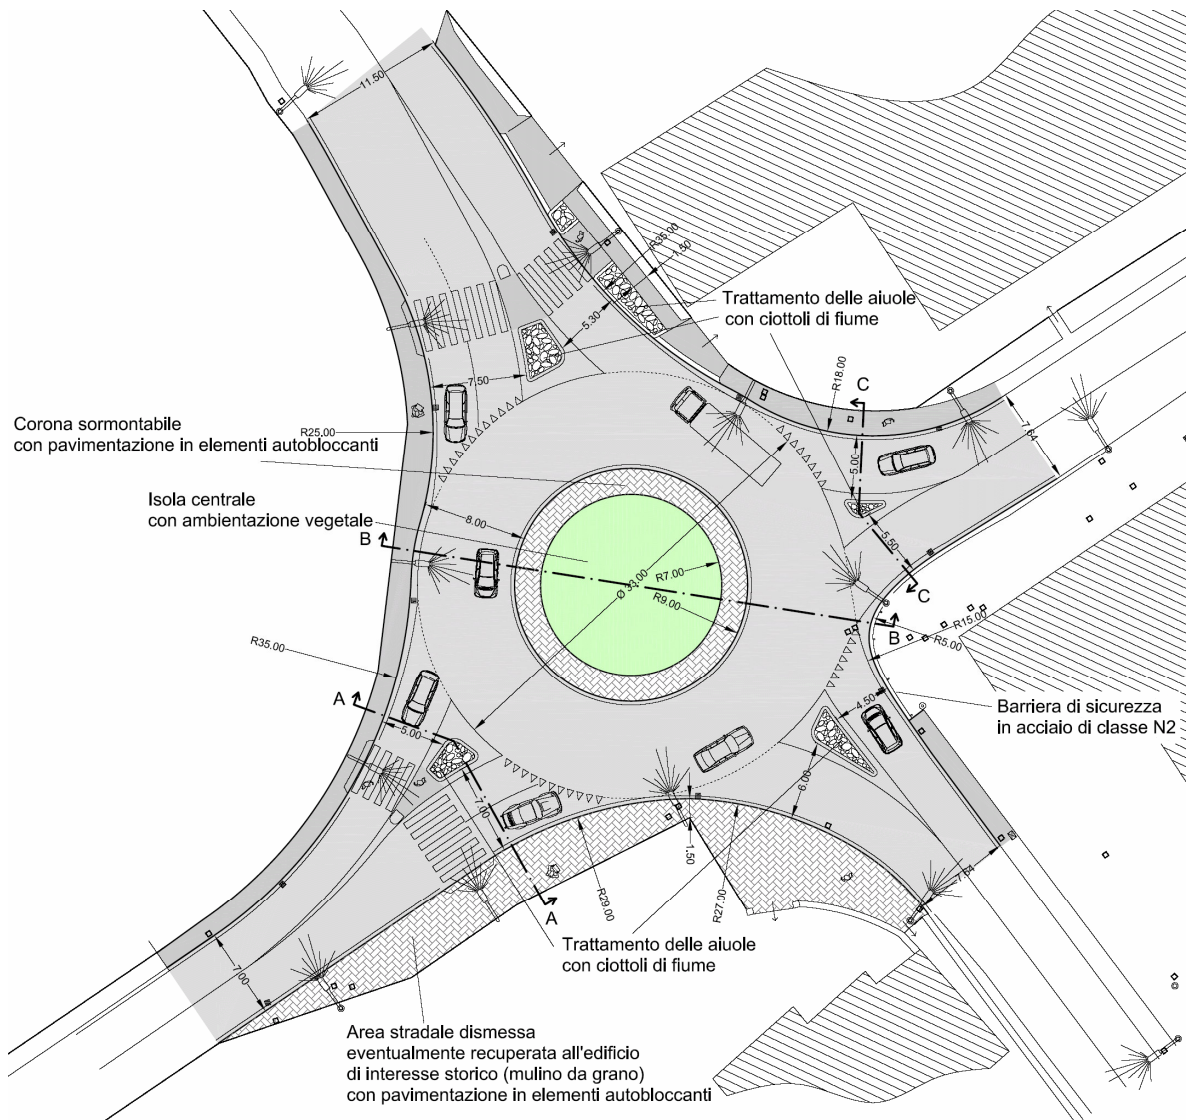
Ipotesi di sistemazione definitiva a rotonda dell'intersezione di via Lungardo – Sarajevo – Dendrofori
